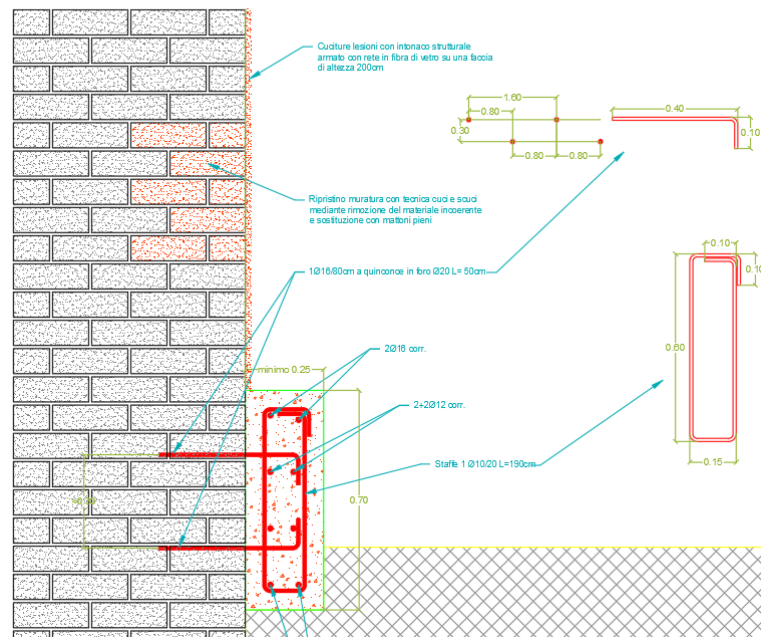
sezione tipologica per ripristino e protezione al piede del muro in mattoni pieni
